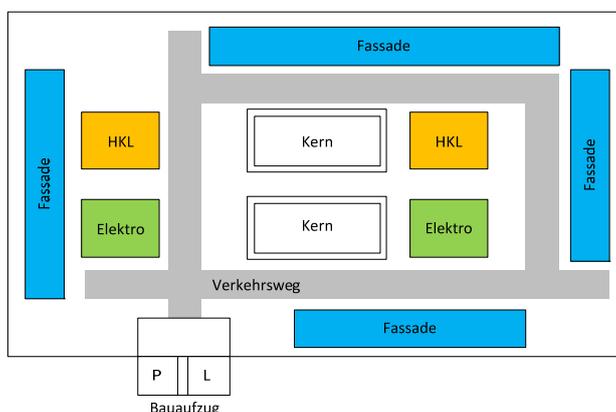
Stockwerkklagerplan – Ausbau I: Fassade, HKL, Elektro
